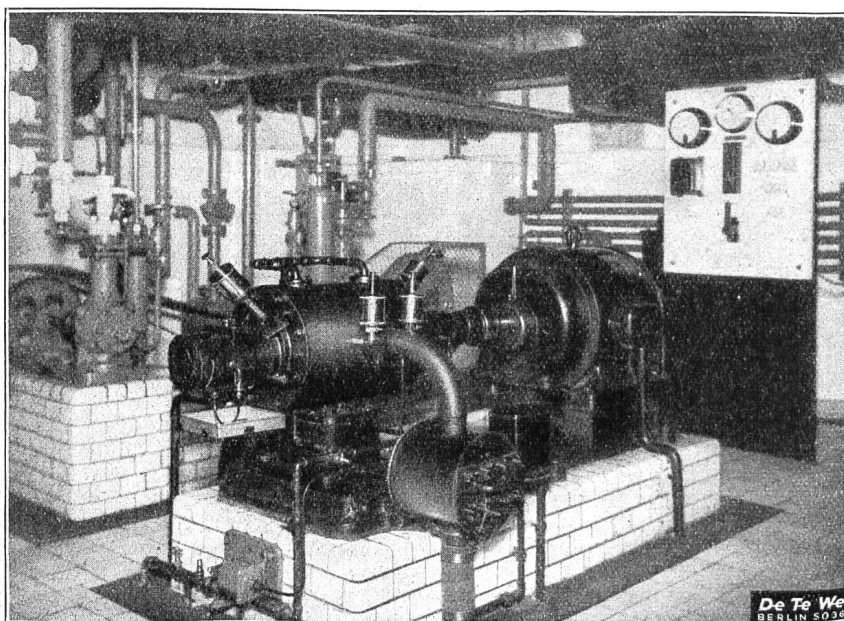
Gebläseaggregat und Kältemaschinenanlage im Maschinenraum des Haupttelegraphenamtes.
